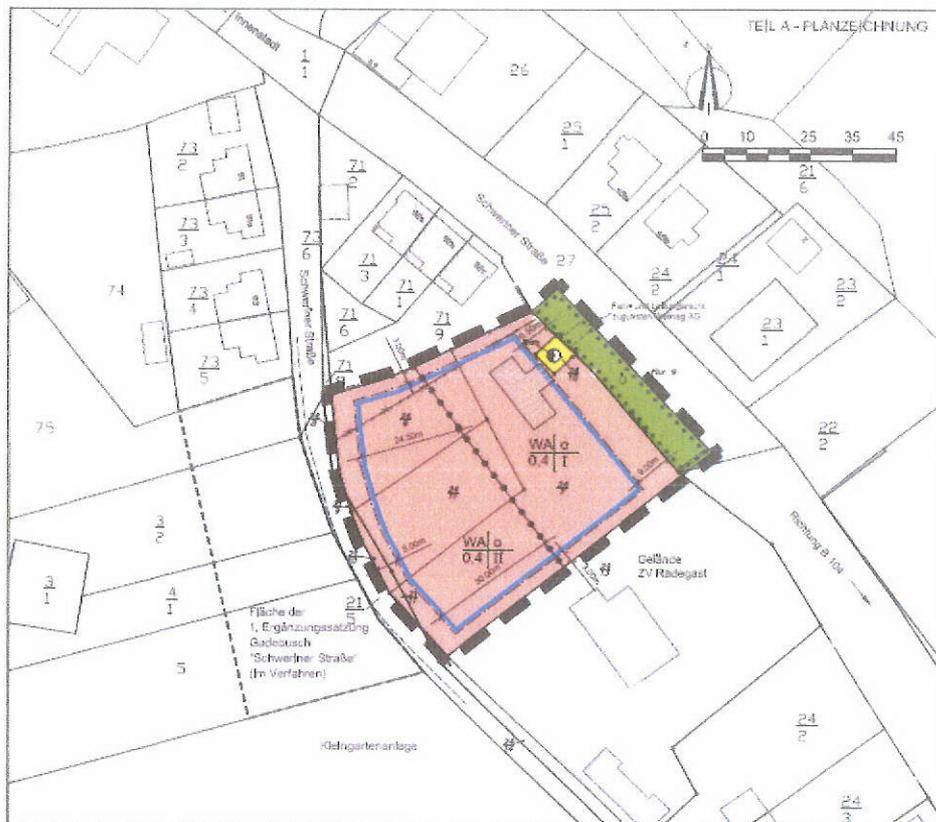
Plangebiet – Auszug aus der Planzeichnung
